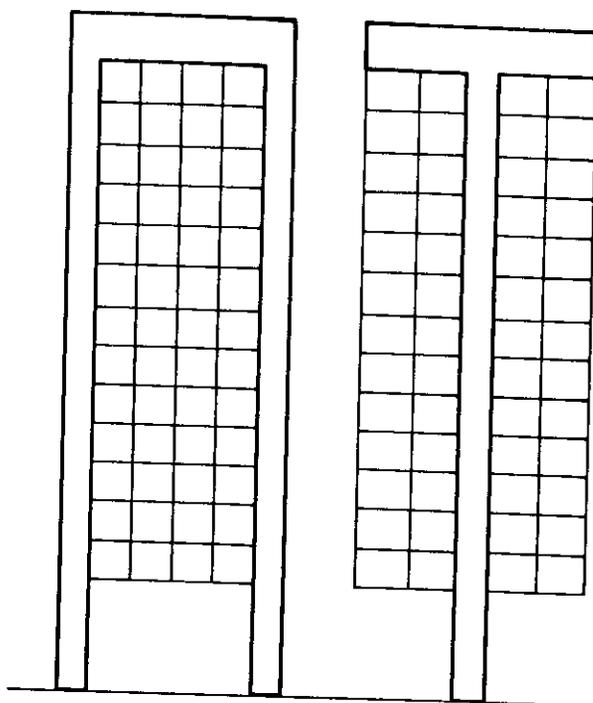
Sistemas Principais de Transmissão de Carga em Estruturas Verticais
